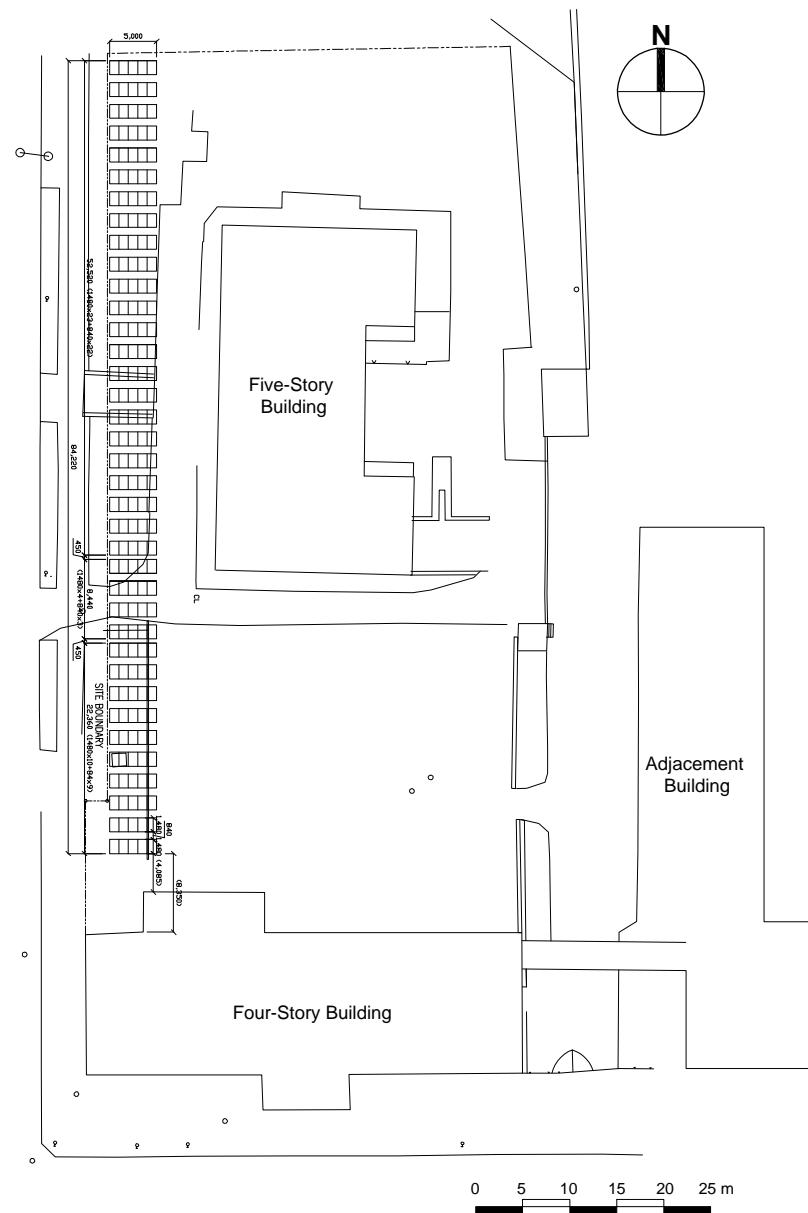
イリア国立大学 支柱及び架台配置図
